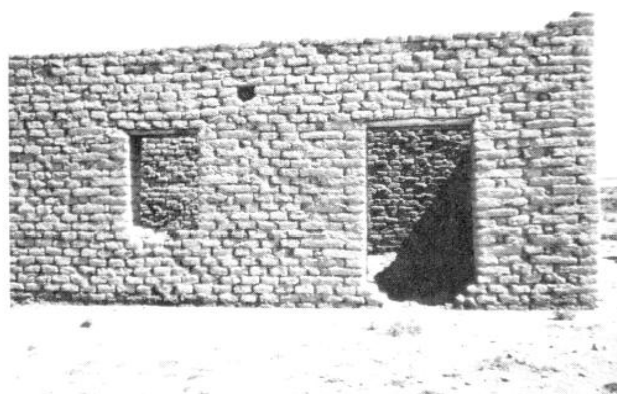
Gros-œuvre d'une maison en construction (Kboueish, Syrie).
